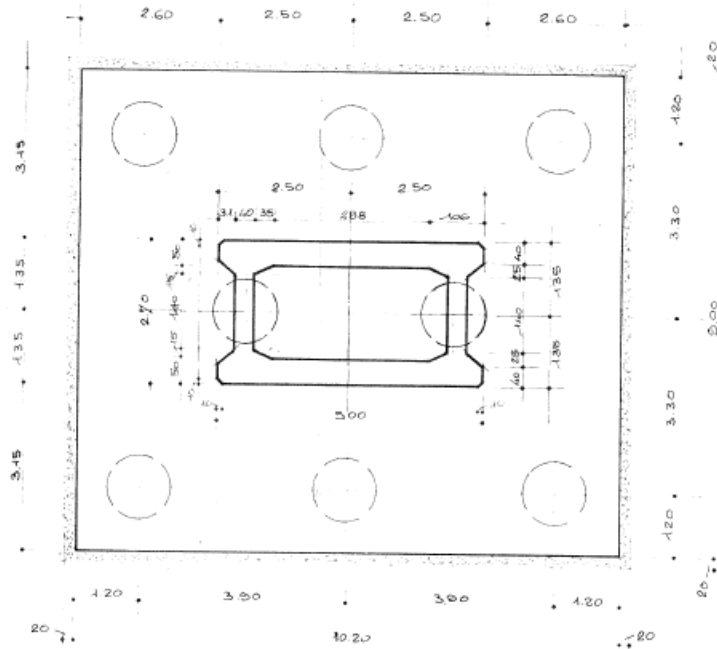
Pianta della fondazione con indicazione dei pali, 8 pali
